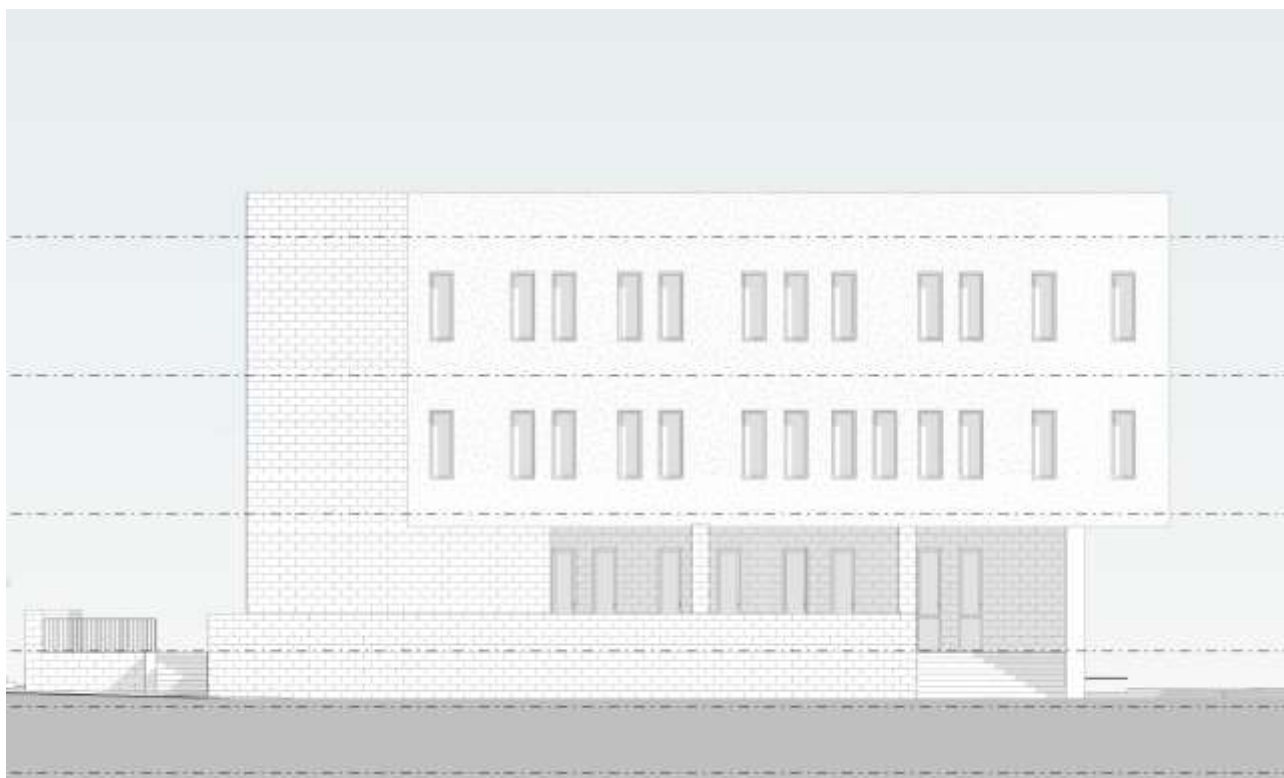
prospetto corte interna, lato via Valfonda (nord-est)
